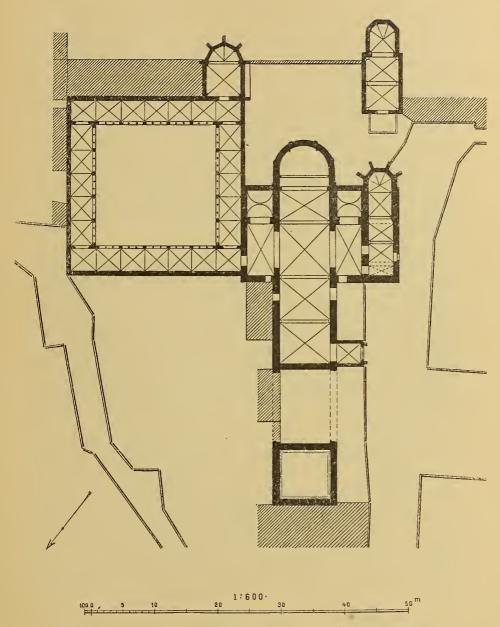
Lageplan der Stiftskirche mit den angrænzenden Gebæuden. (Mit Ergænzung der jetzt nicht mehr bestehenden Theile des Kreuzganges.)
